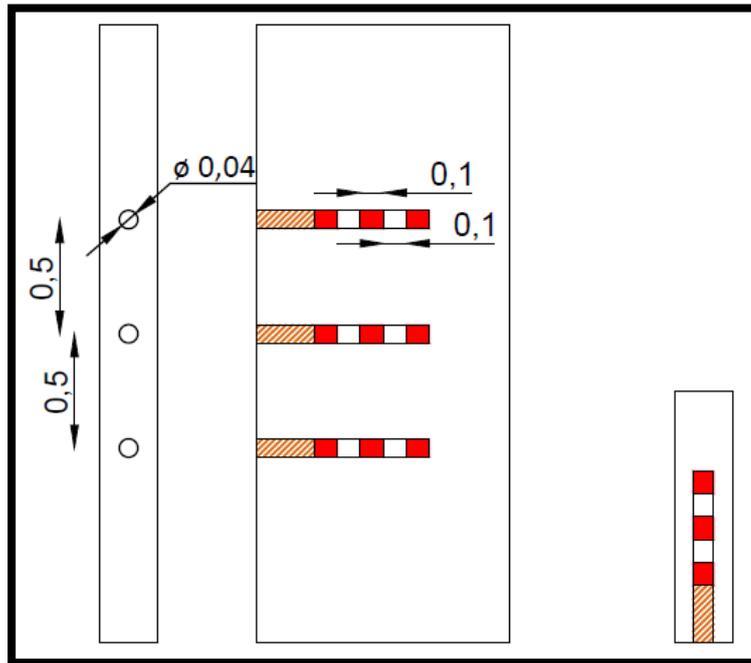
Alzado, perfil y planta del pilar "Refuerzo 2".
